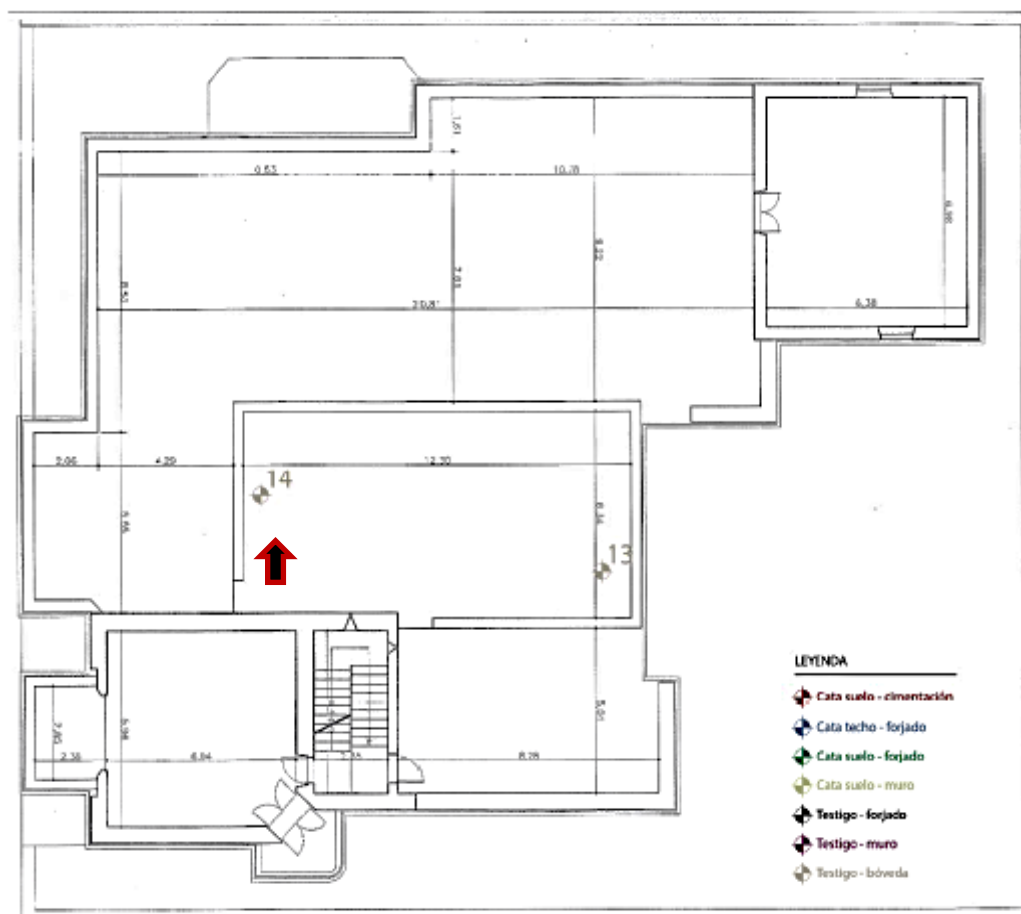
Ubicación extracción de testigos Planta Primera. Villa el castillito. Sanlúcar de Barrameda. (Fuente Songea).
